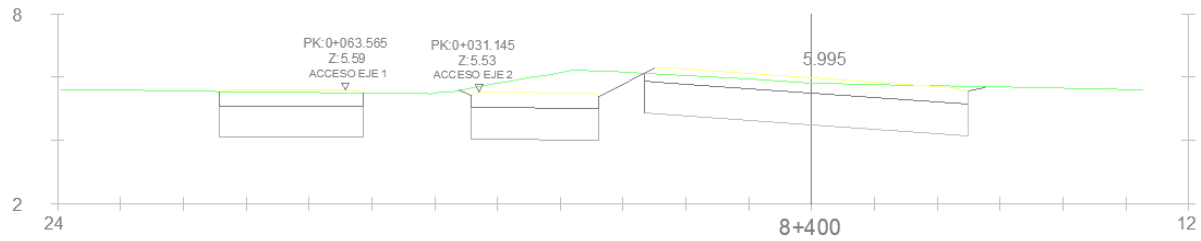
Perfil transversal de la zona de conexión proyecta de nuevo vial con las instalaciones de Bidegi.
